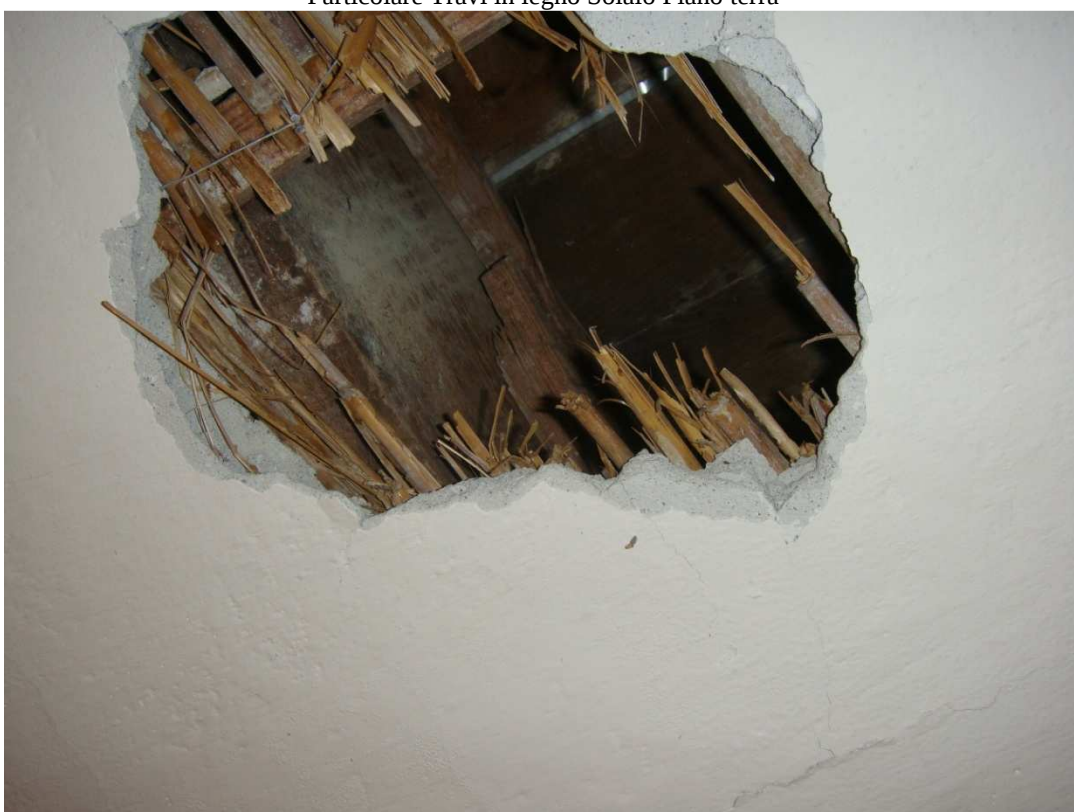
Particolare Solaio in legno Piano Primo con cannicchio quale controsoffitto
